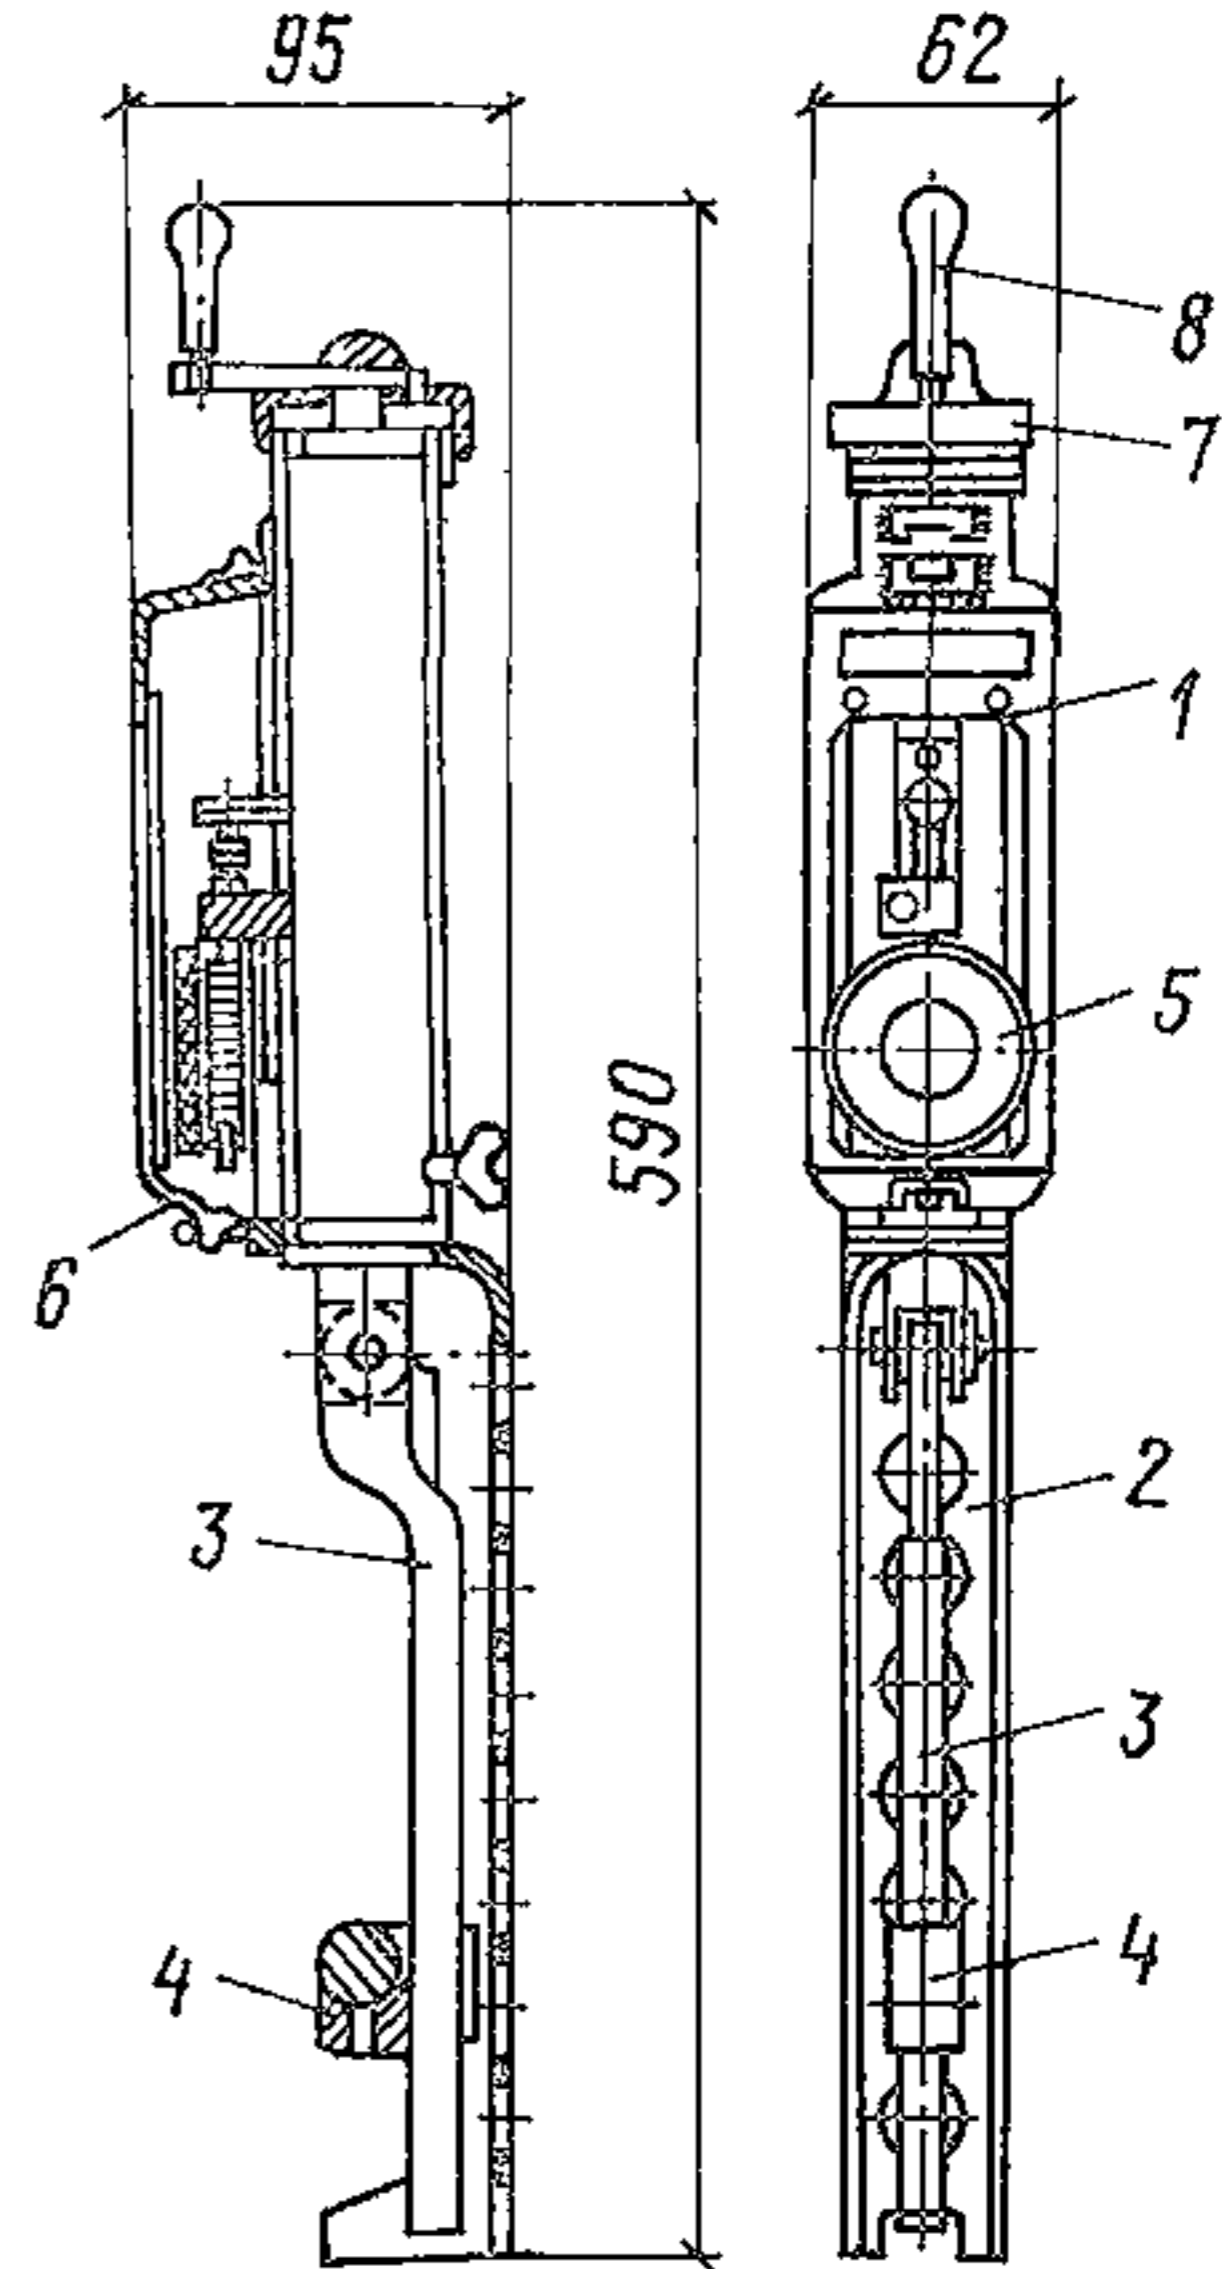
Прибор для контроля величины натяжения арматуры типа ПРДУ
